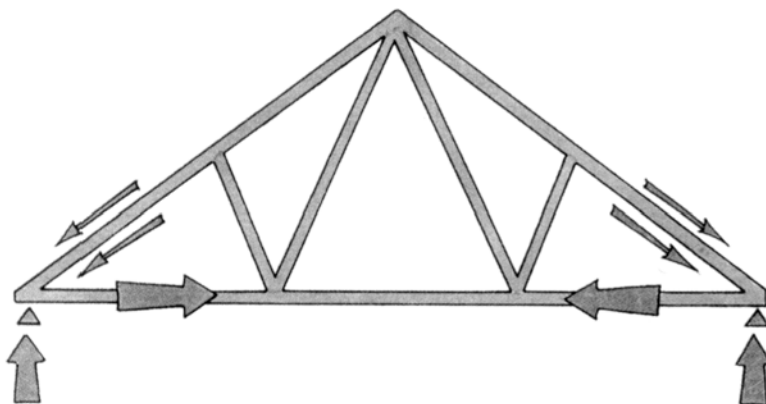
Ferme avec entrait horizontal. L'entrait referme les forces sur la ferme, qui transmet des efforts horizontaux réduits aux appuis.
